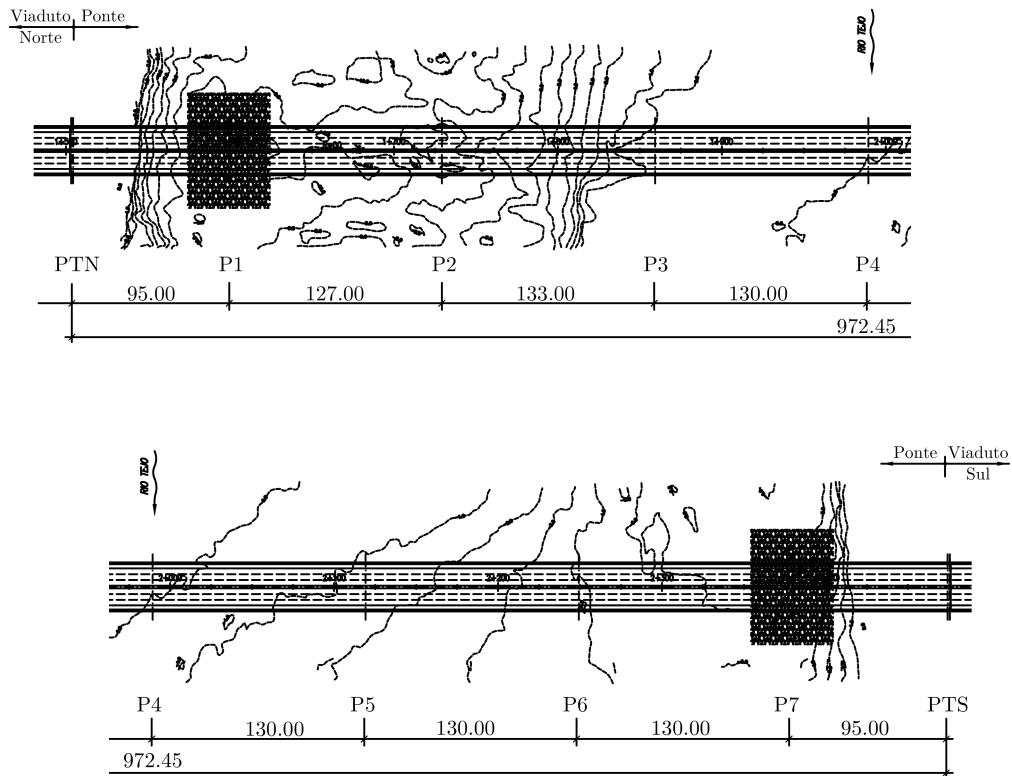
Traçado em planta da Ponte da Lezíria.
